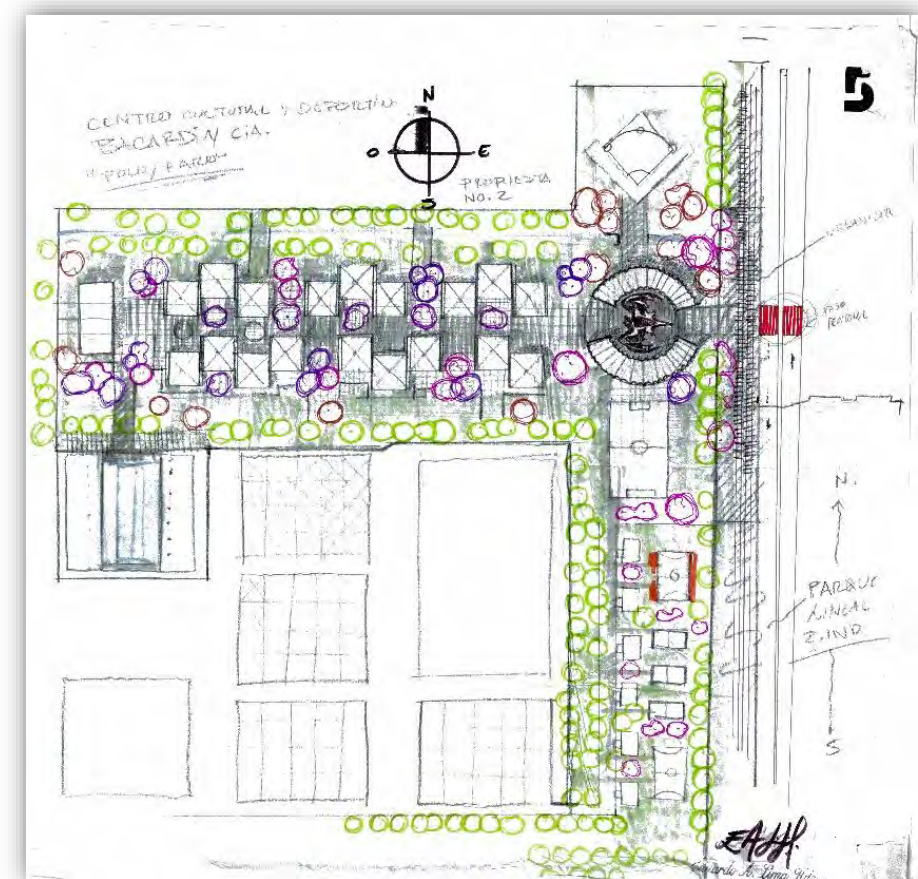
Variable de la primer Planta General de Conjunto Abril 2018
